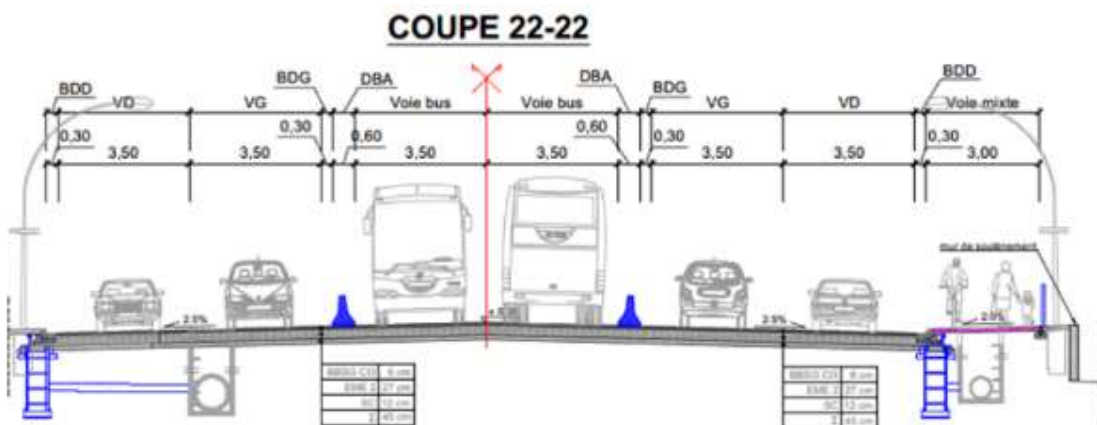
Profil en Travers – Section courante sur le boulevard de la Paix, partie Sud
